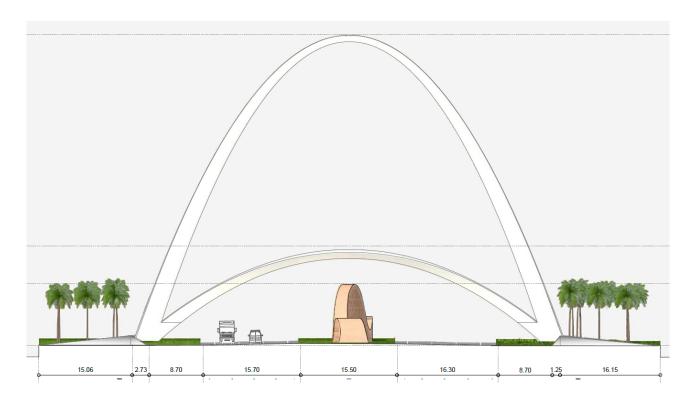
Puerta de entrada a Jeddah en dirección Medina. Alzado
